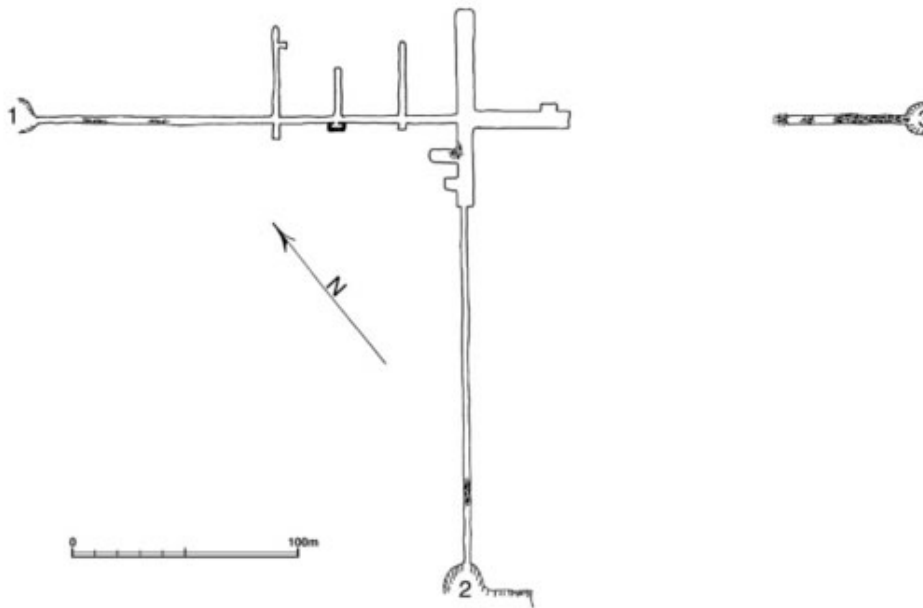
Plan podziemnych wyrobisk (kompleks „Osówka”)
